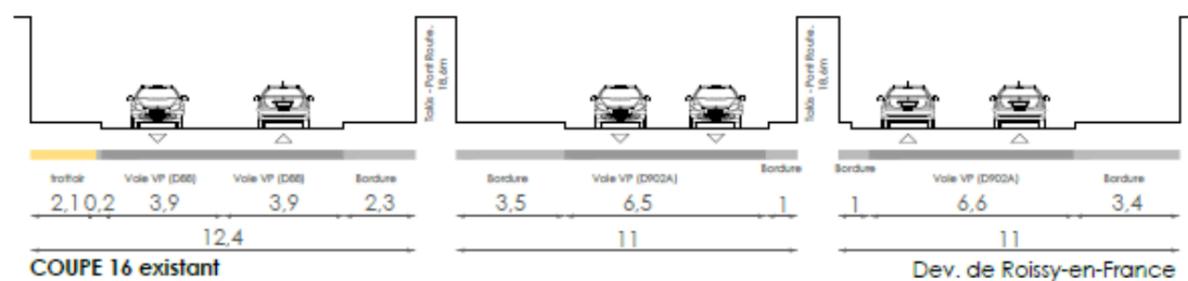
profils existant et projeté sur la RD88 entre le giratoire Hyatt et la rue de la Belle Borne
